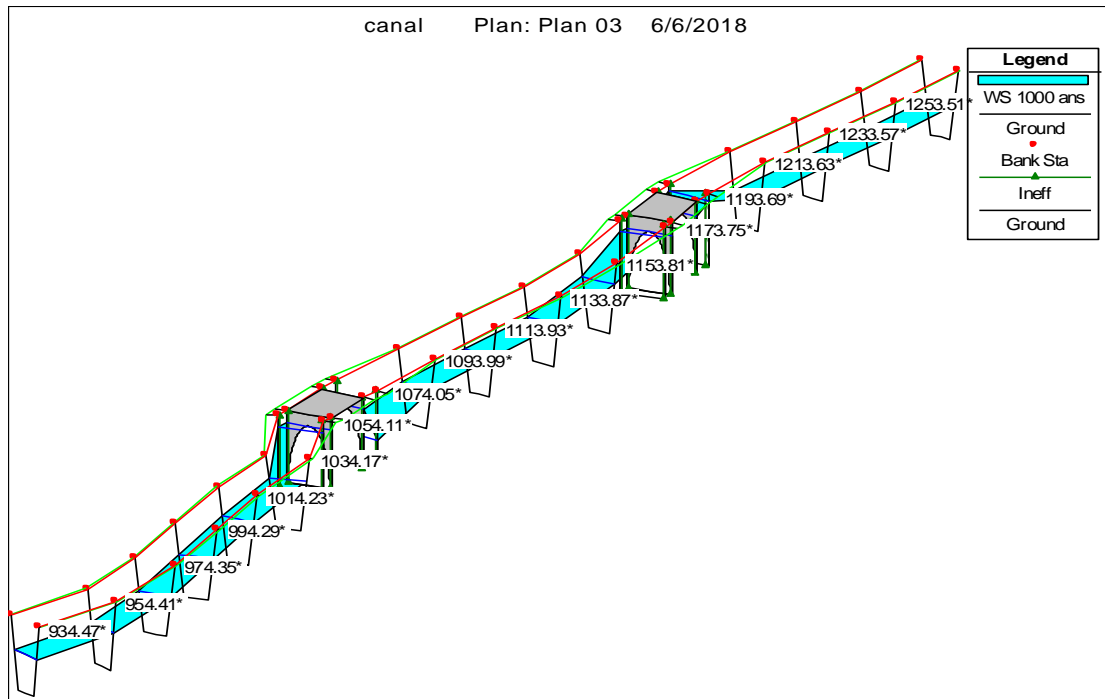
Vue en Plan en 3D de deux ponts cas canal trapézoïdal
